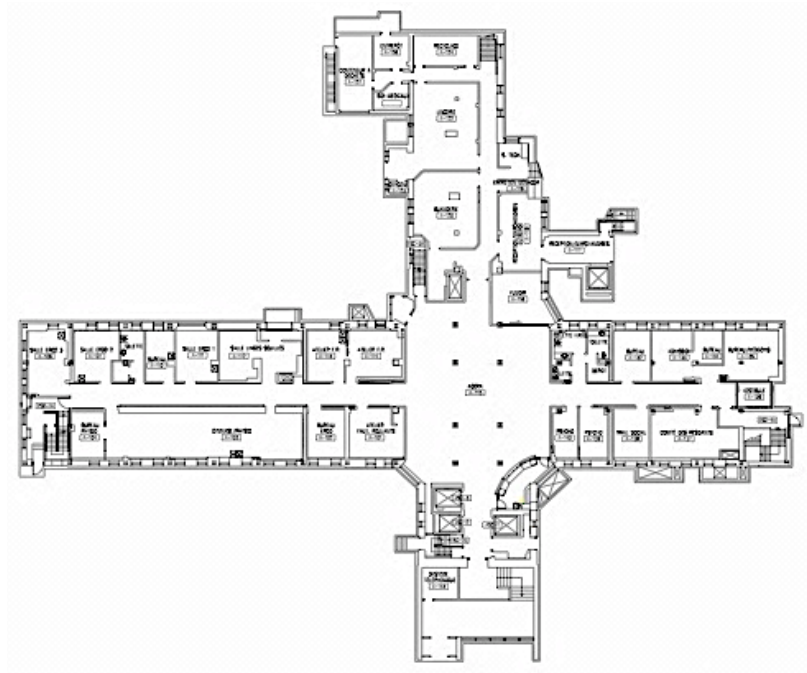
Plan du rez-de-chaussée. Centre d'hébergement A. Autorisation de reproduire et de modifier fournie par M. Bruce Lapointe, Chef de service mesures d'urgence et sécurité du CSSS Jeanne-Mance.
